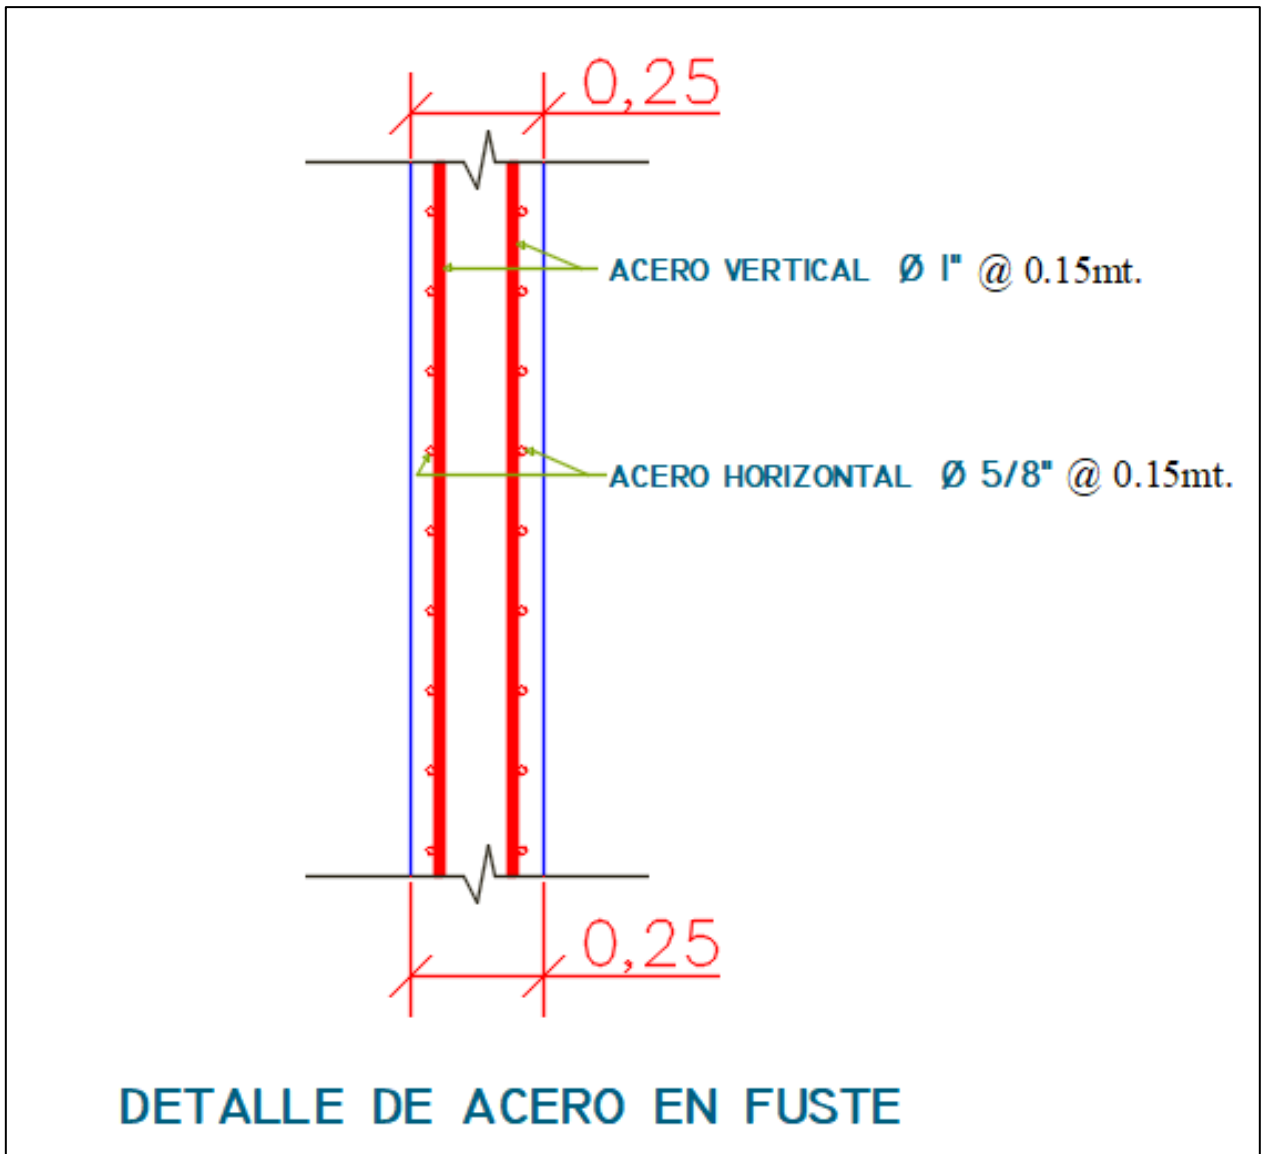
Plano de detalle de distribución de acero del muro fuste.
